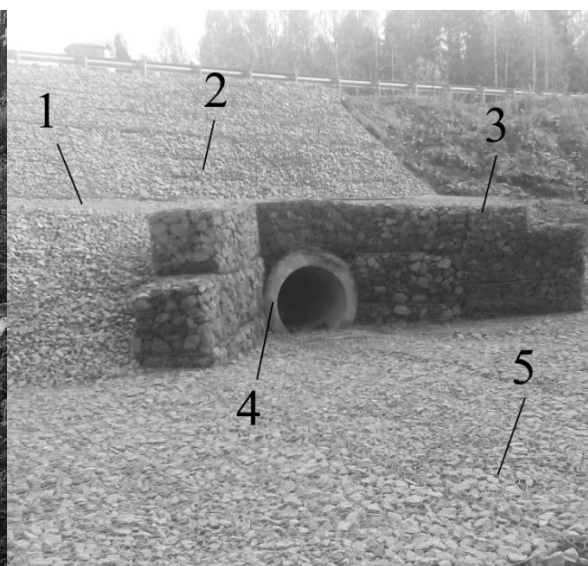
Укрепление насыпи (1 – берма, 2 – укрепление откосов, 3 – габионы коробчатые, 4 - звено трубы, 5 – укрепление лотка)
